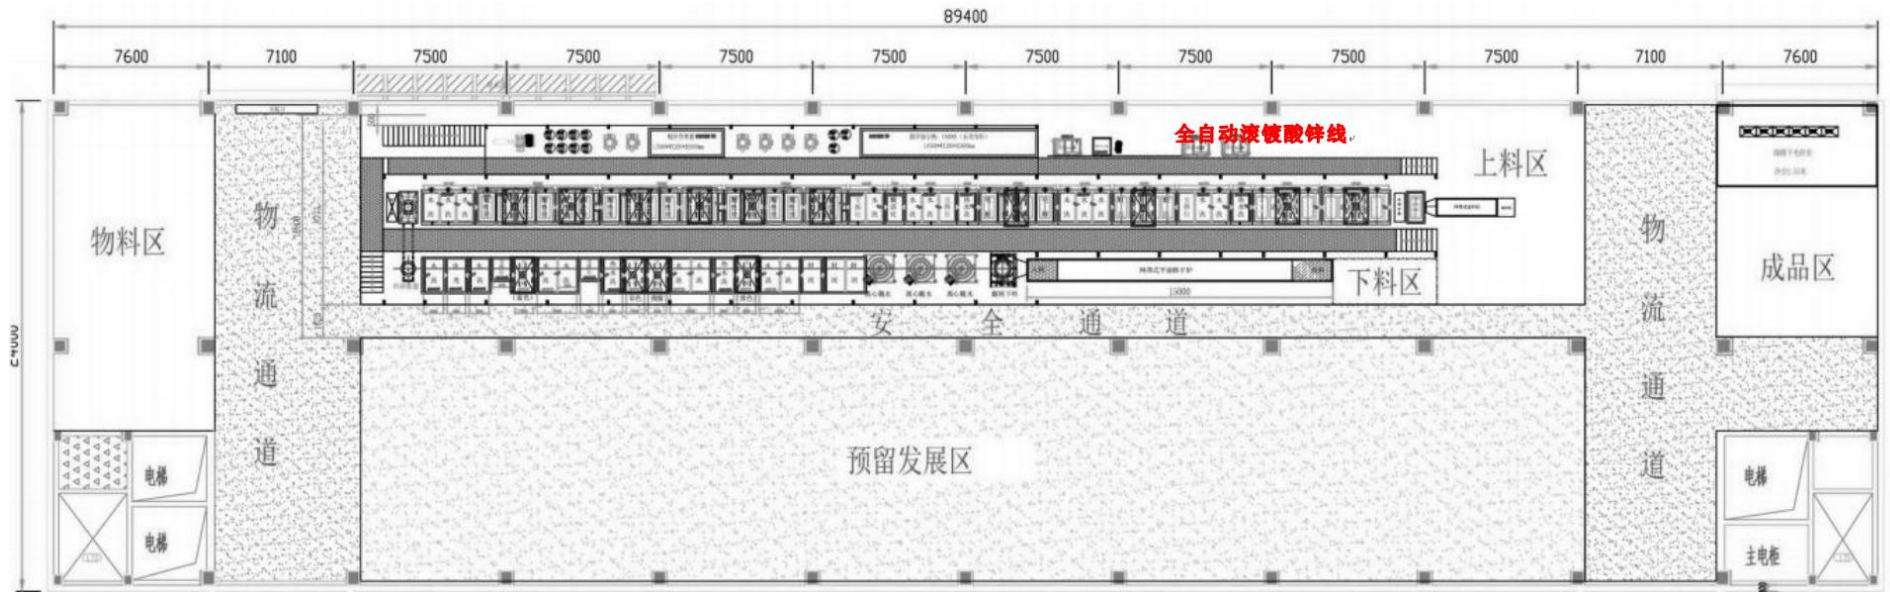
厂房 3 二楼电镀车间（全自动滚镀酸锌线）平面布置图
